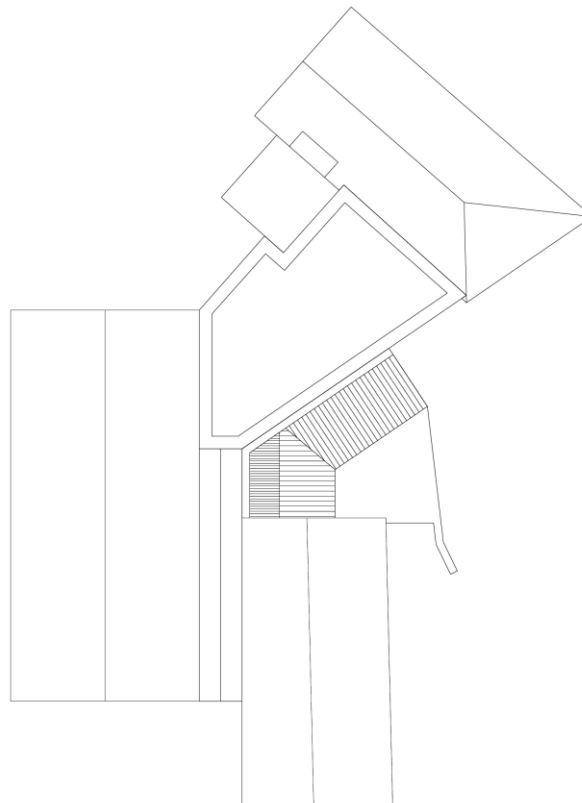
Dachaufsicht der Gebäude Kirchgasse 1 und 3
